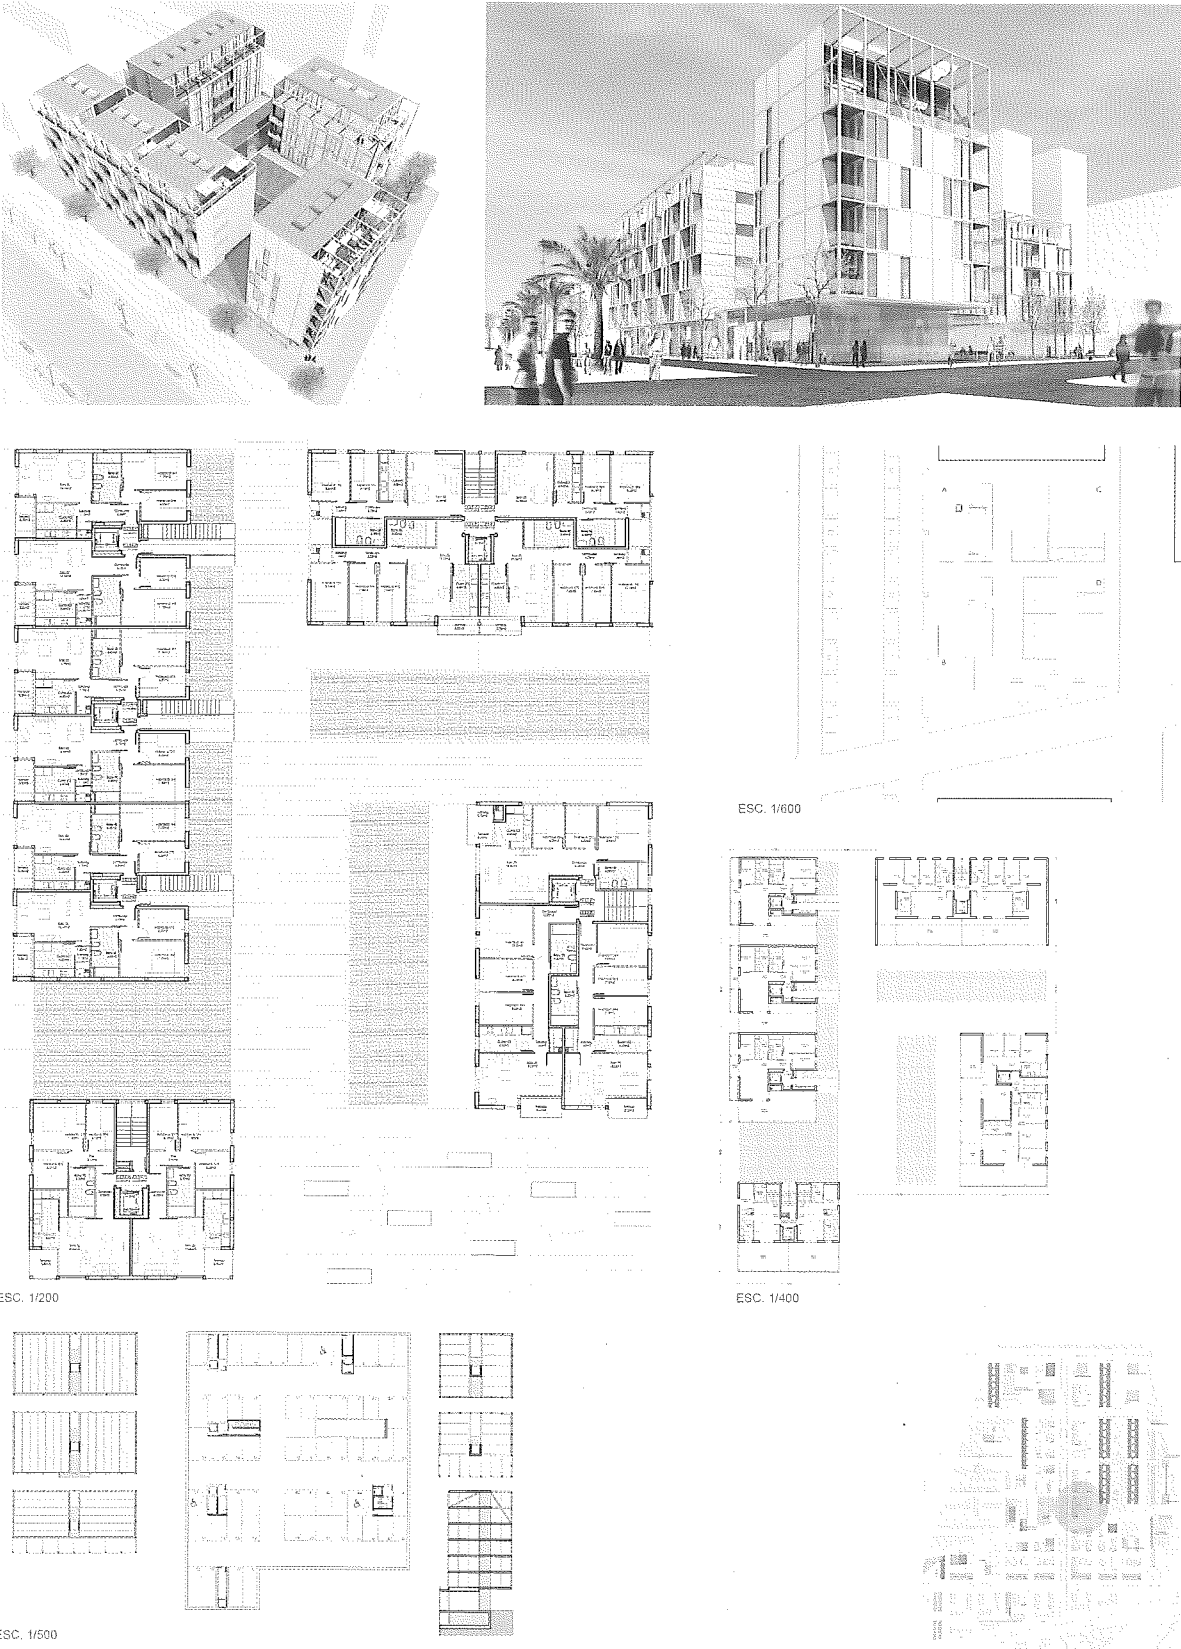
Proyecto para la manzana R-5b de BAMMP. Axonométricas, planta tipo, planta baja, planta de áticos, planta bajo rasante y localización.
